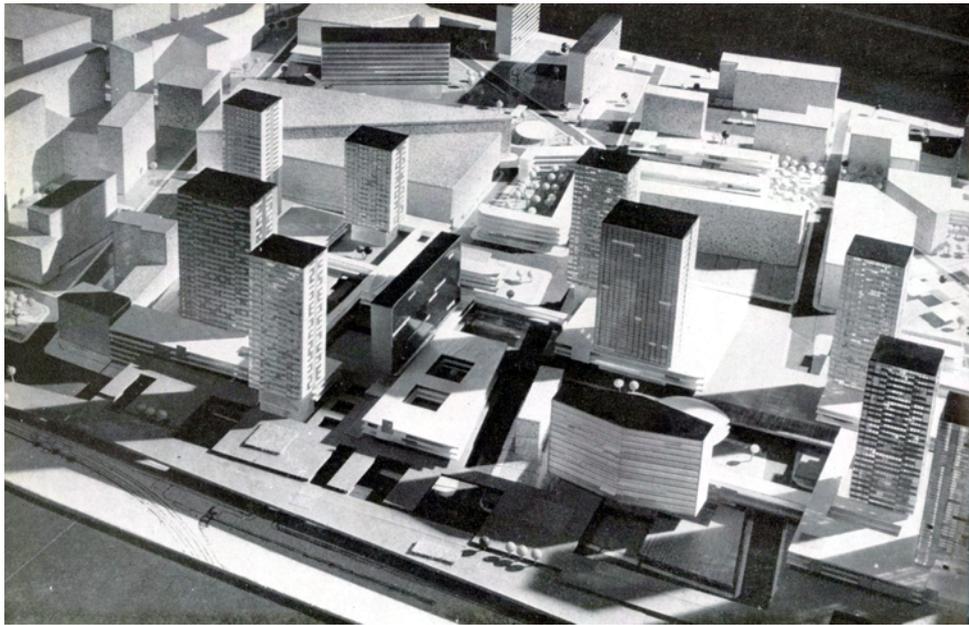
Bebauungsplan für ein Pariser Viertel
